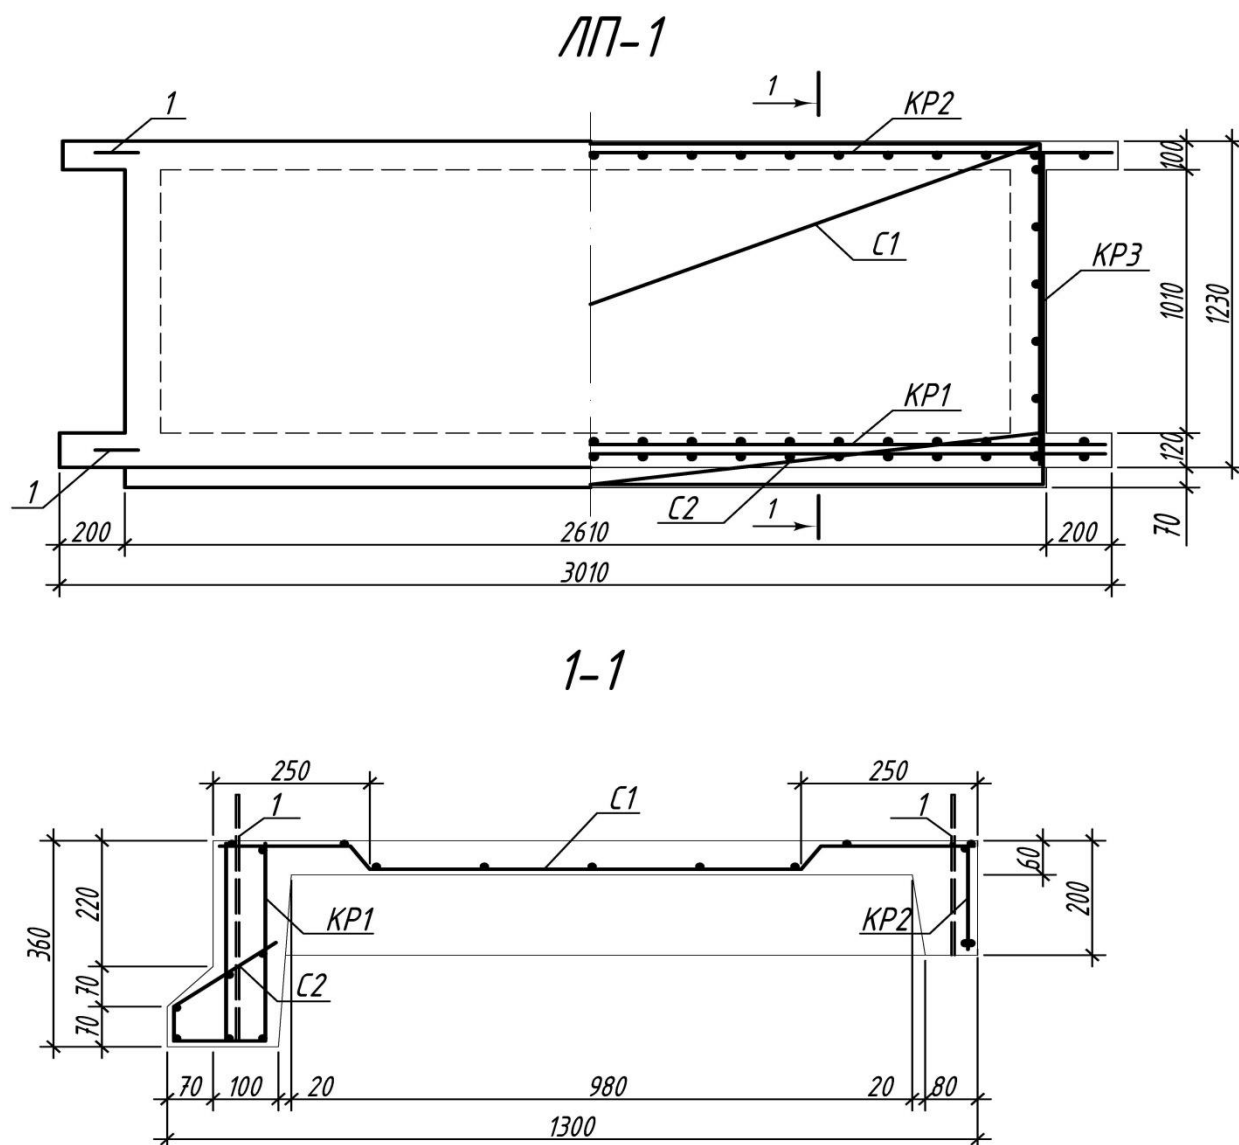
К расчёту плиты лестничной площадки. Общий вид и детали армирования.
